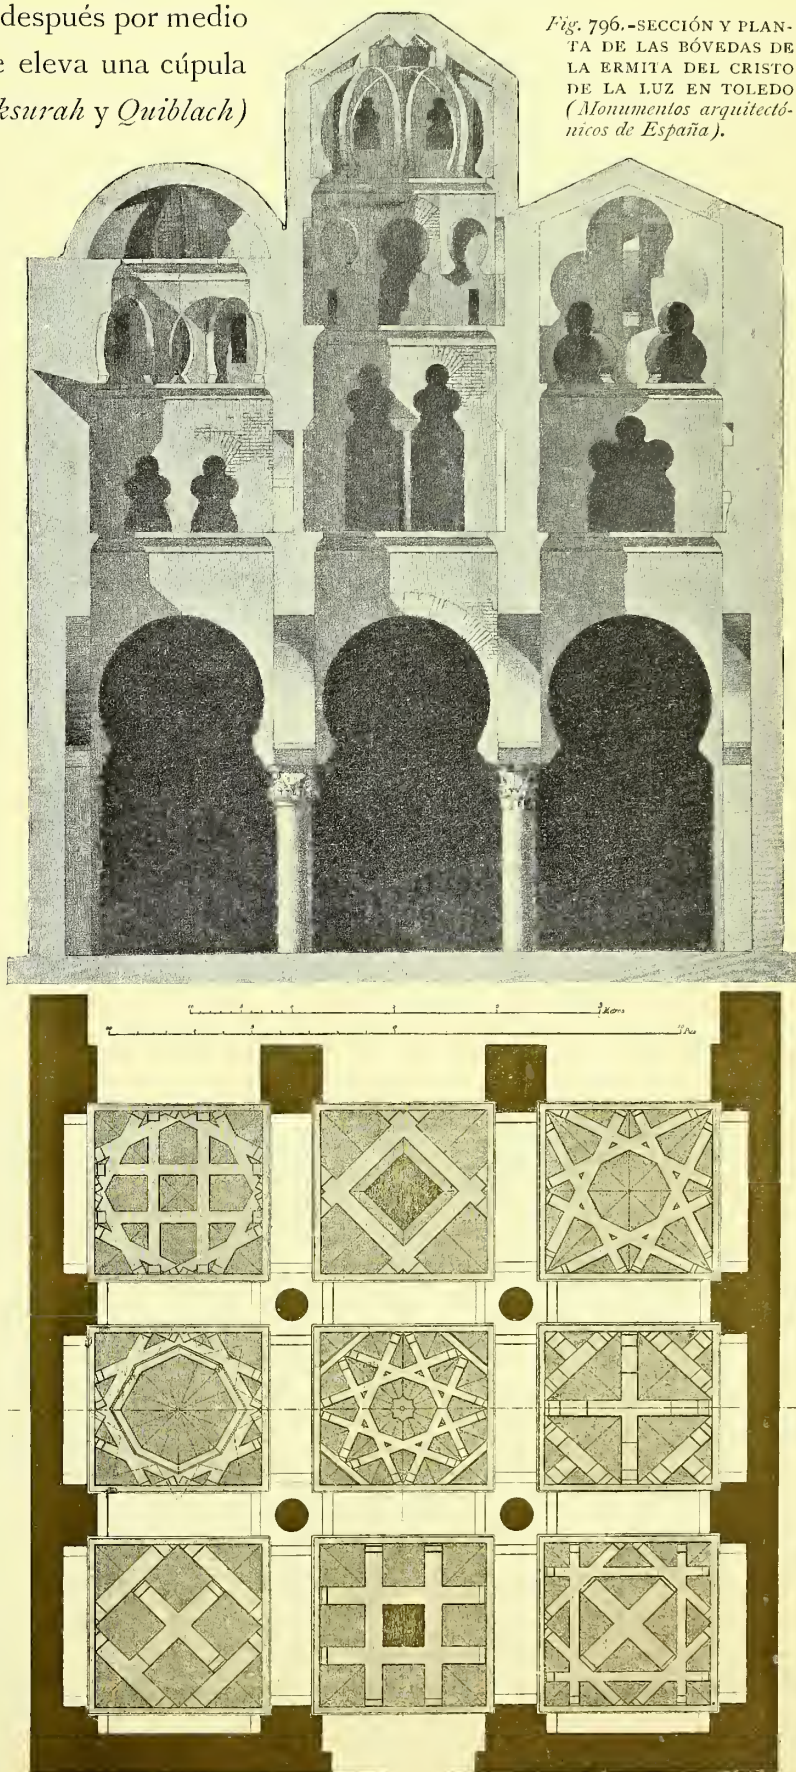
SECCIÓN Y PLANTA DE LAS BÓVEDAS DE LA ERMITA DEL CRISTO DE LA LUZ EN TOLEDO (*Monumentos arquitectónicos de España*).
